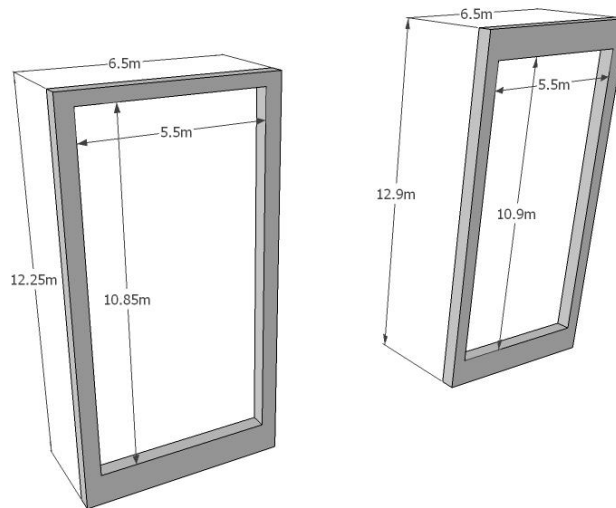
Detalle de los muros – Superboard, fachada norte – *DesignBuilder
